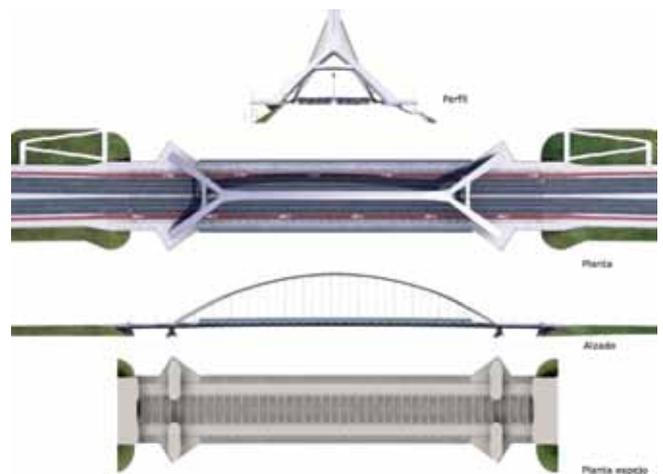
P3M. Alzados y plantas del puente del Tercer Milenio
